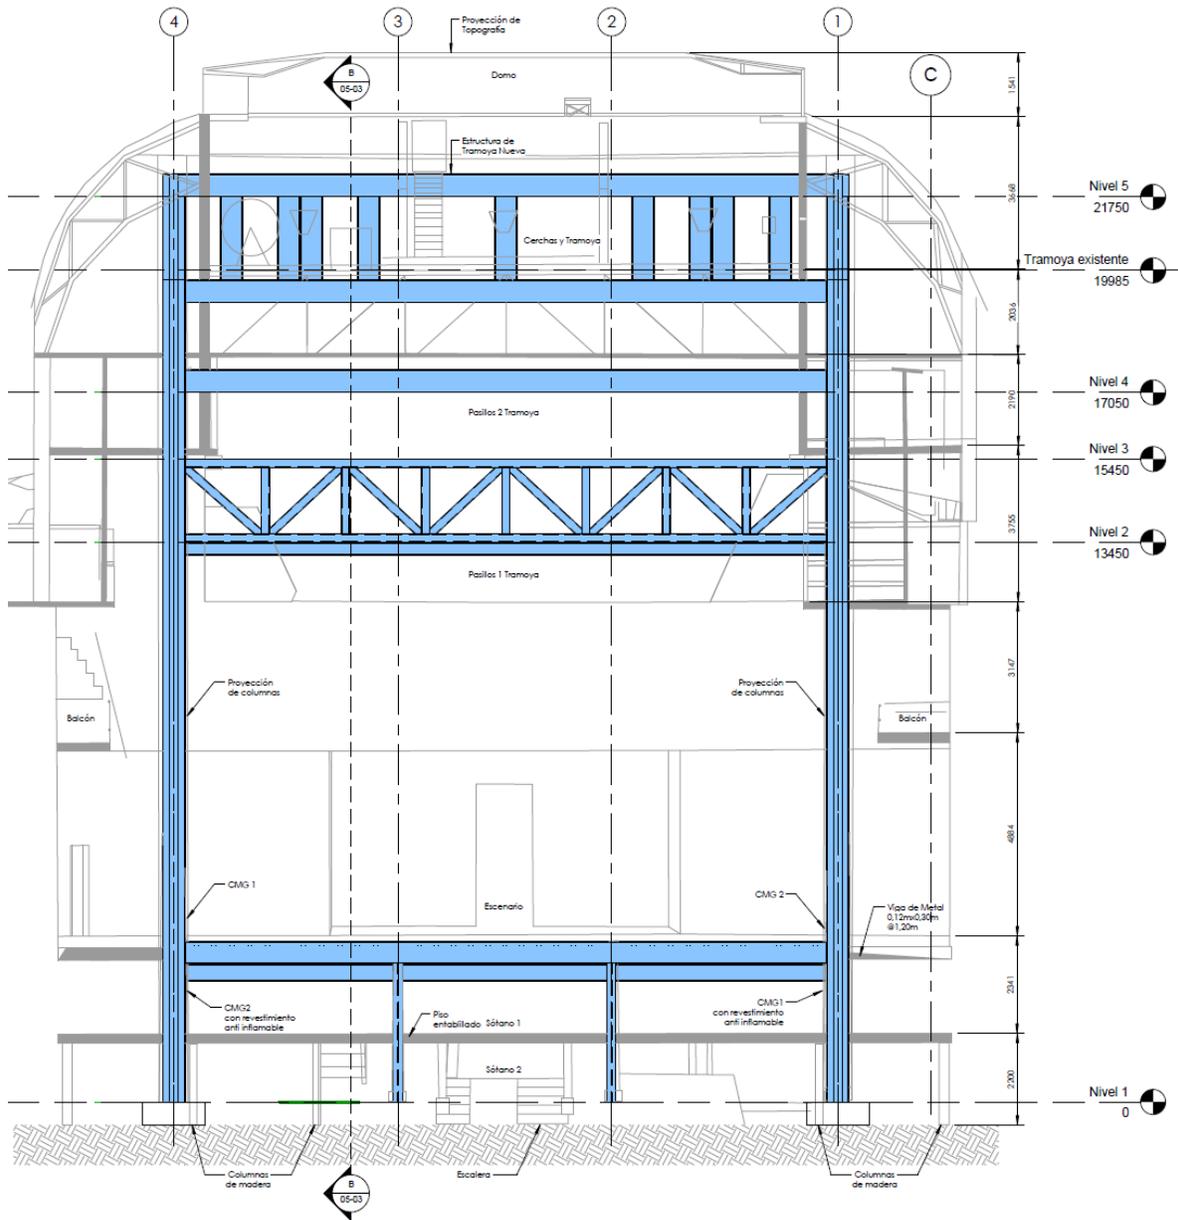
Interacción Caja Escénica - Estructura de Tramoya- Vista Frontal.
